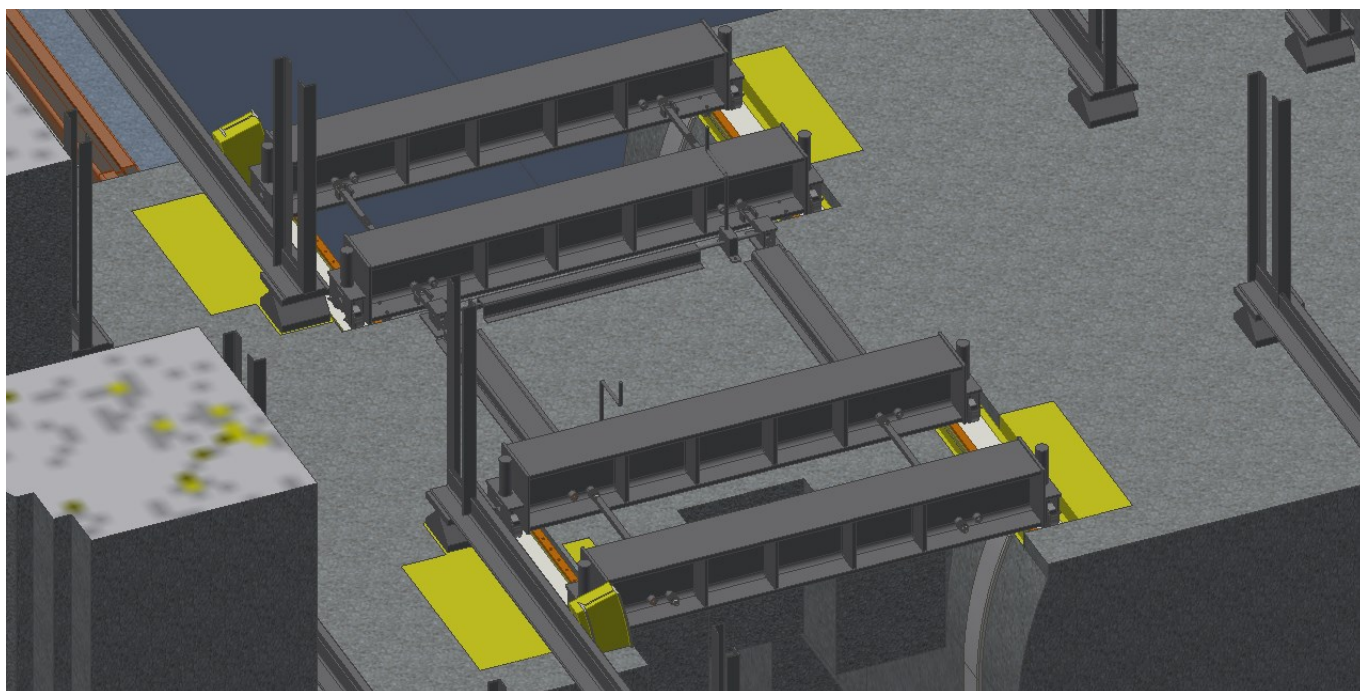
Implantation du dispositif dans la pile centrale, au niveau supérieur
